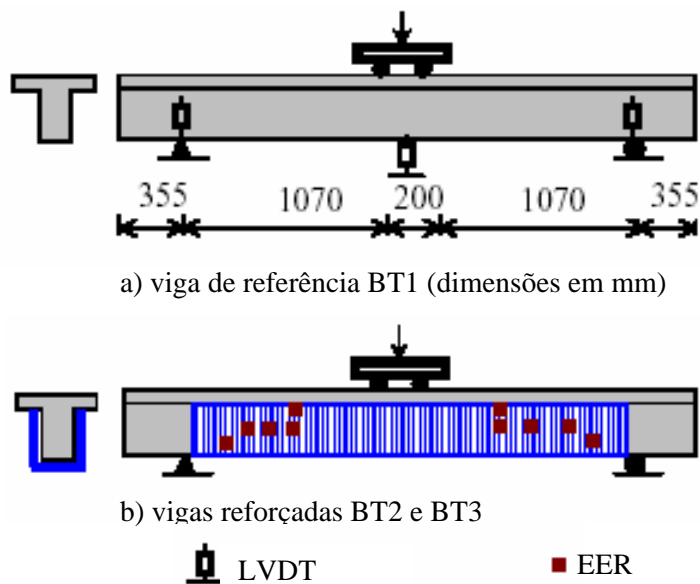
Esquemas das vigas ensaiadas e da instalação dos LVDT e dos EER; adaptada de Khalifa *et al.* (1999).
